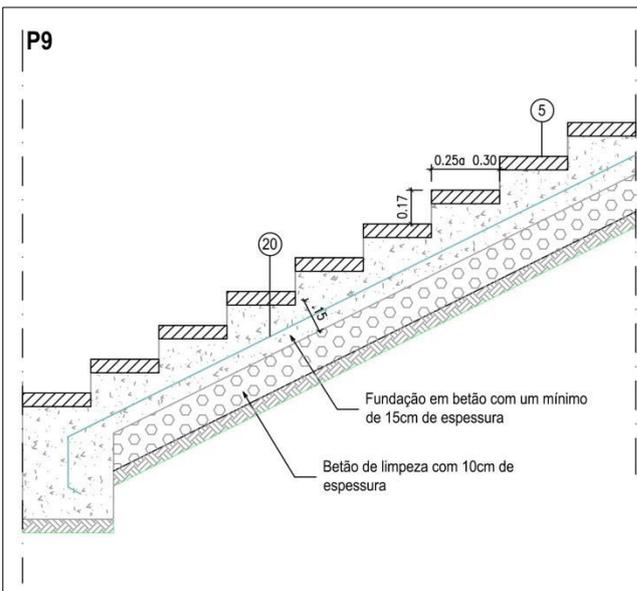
Pormenores de Construção do Projeto de espaços exteriores no Museu Francisco Lacerda, Açores
